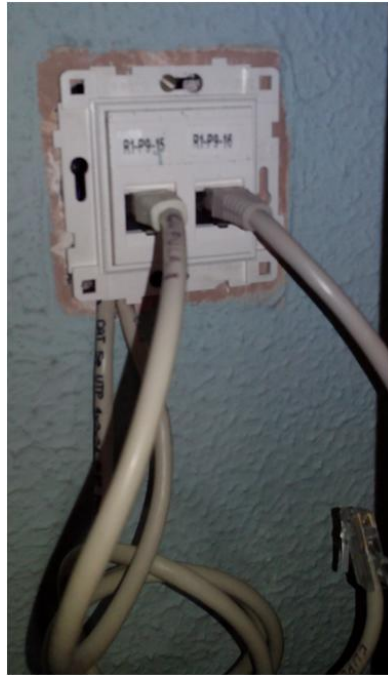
Roseta planta inferior toma R1-P9-15.
